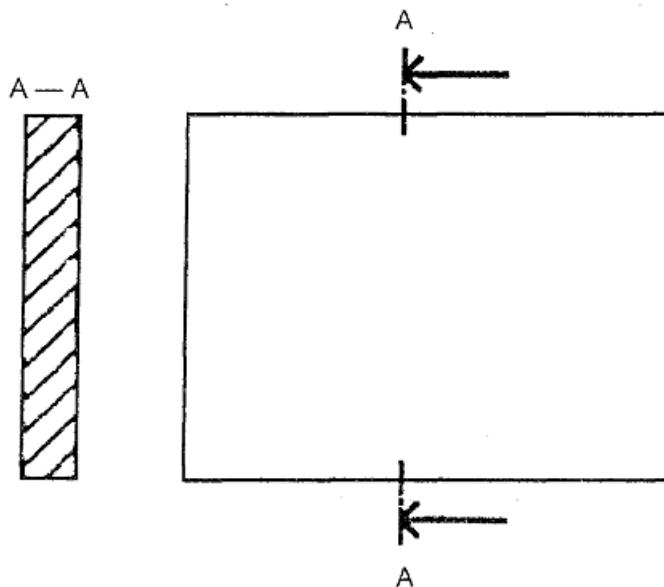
Приклад зображення перерізу на будівельних креслениках
